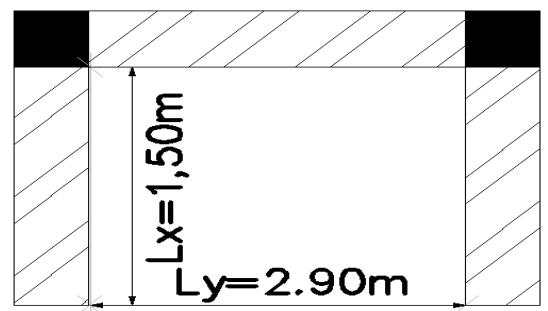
Ferrailage de la dalle sur trois appuis
